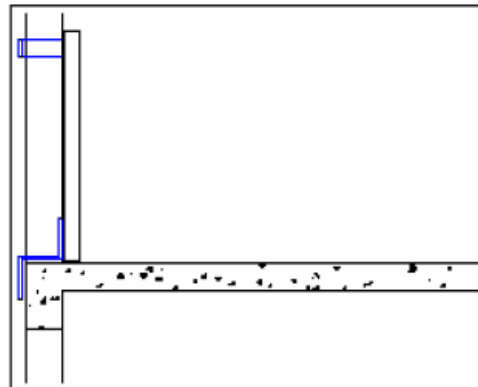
Fixação de GcR na estrutura da caixa de elevadores
